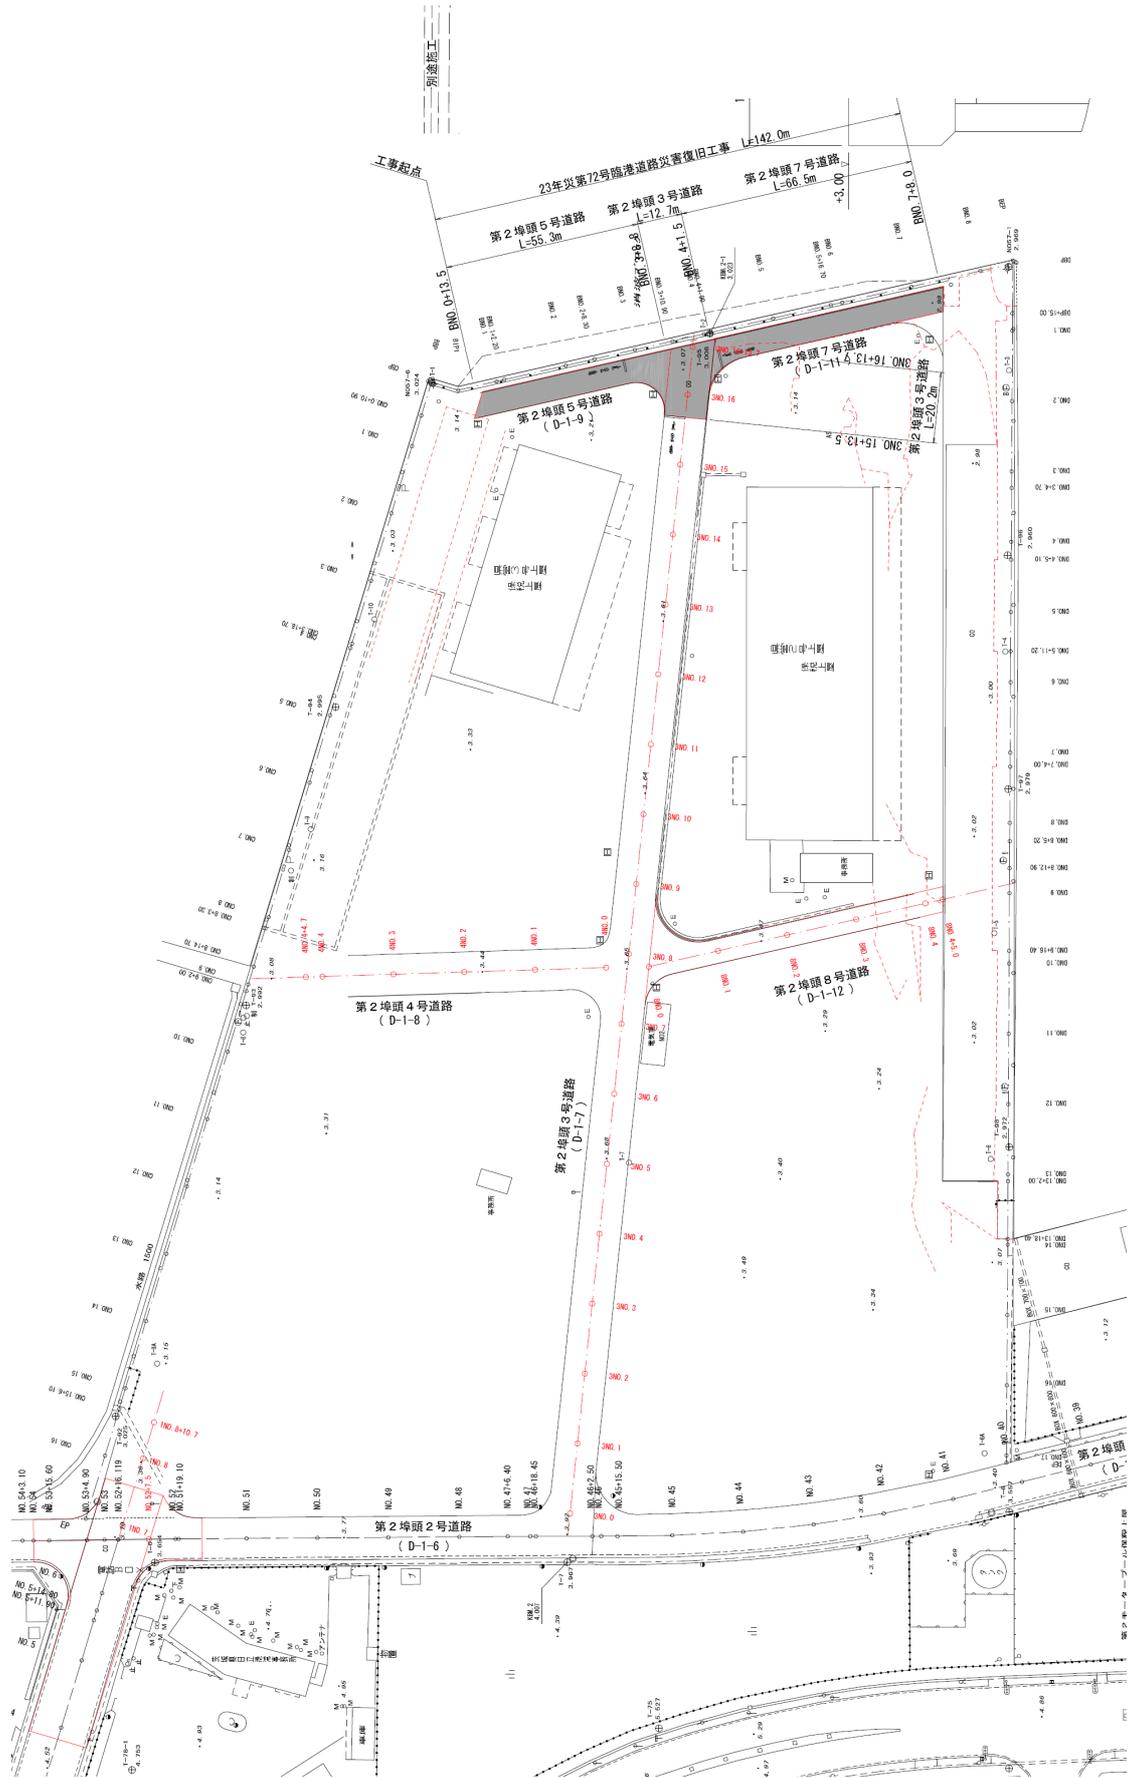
No.3 日立港区_第2埠頭3号・5号・7号道路の平面図(復旧後)
